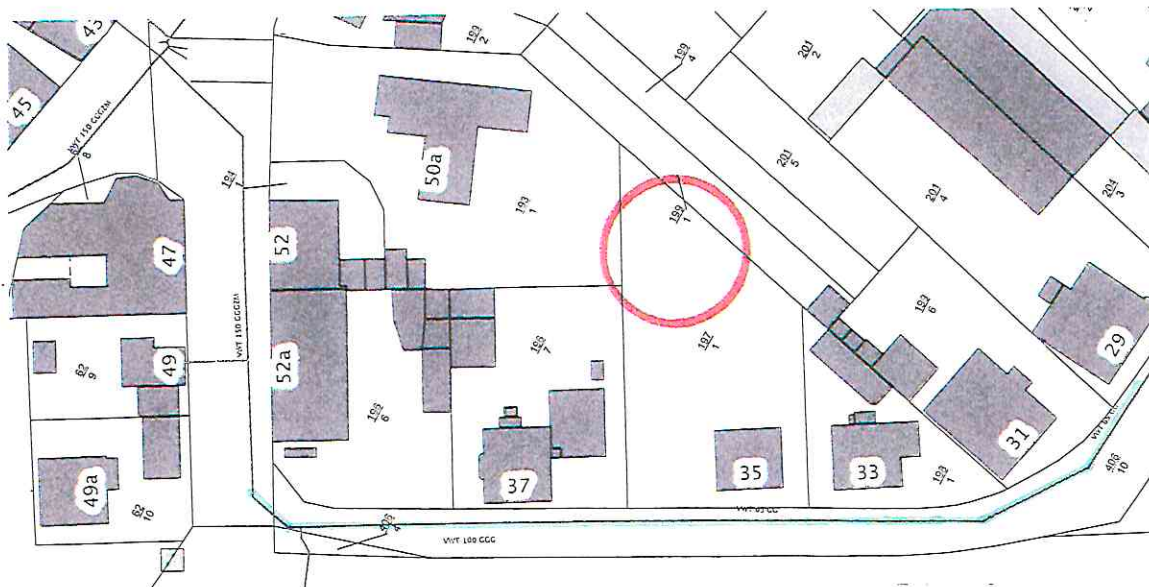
Trinkwasserleitungen, Bestand (Quelle: Gemeinde Glauburg)
